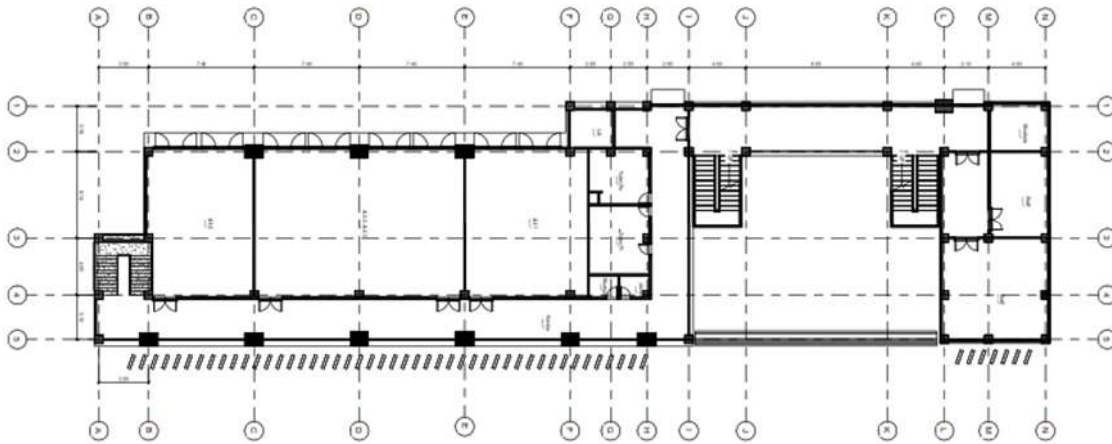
4 Denah Lantai 3 Bangunan Gedung A Vokasi UNDIP
